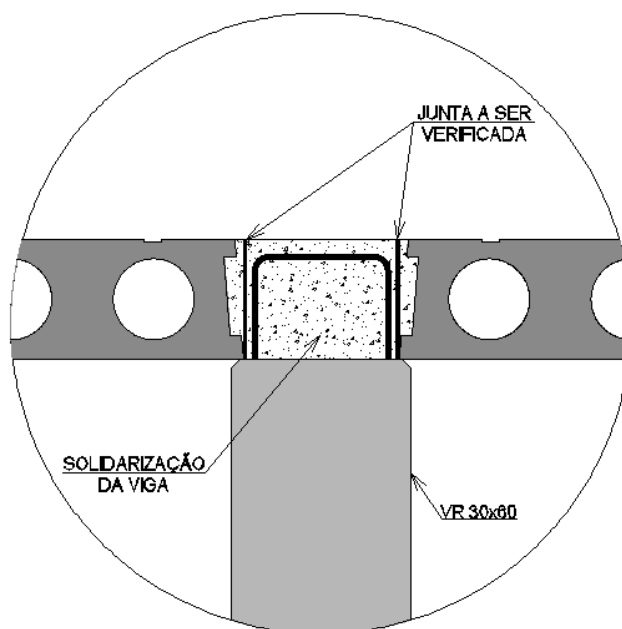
27 – Junta a ser verificada: região entre laje e vigas do pórtico.
